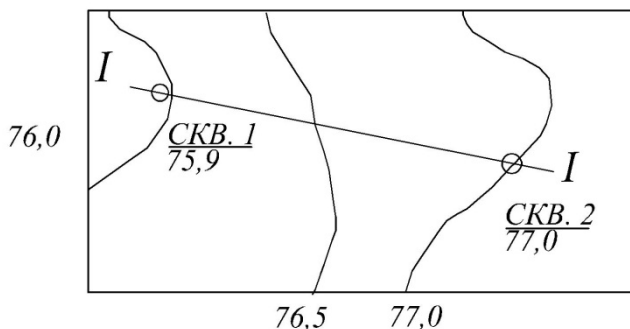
Схема расположения выработок грунта (план) на строительной площадке (пример 4.5)
